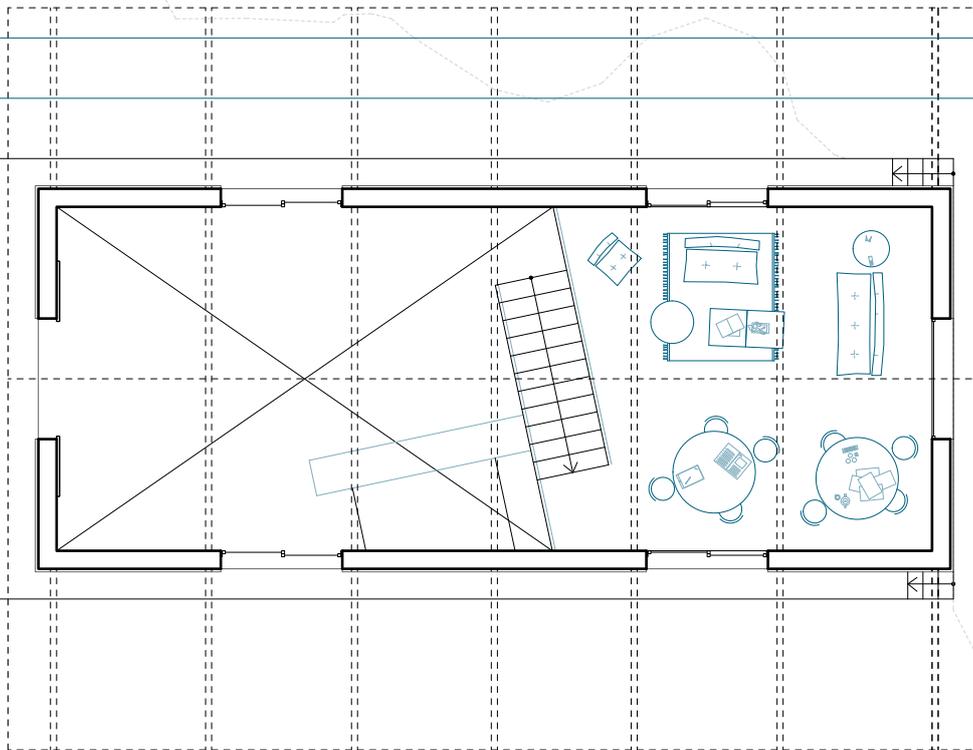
Planta do Cais coberto - Primeiro Piso
